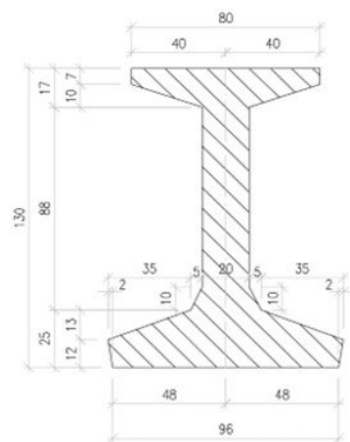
Seção Transversal – Apoios superestrutura contínua
